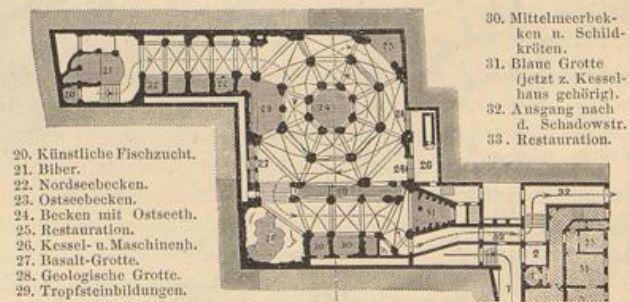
Grundriss des unteren Stockwerkes (Aquarium).
